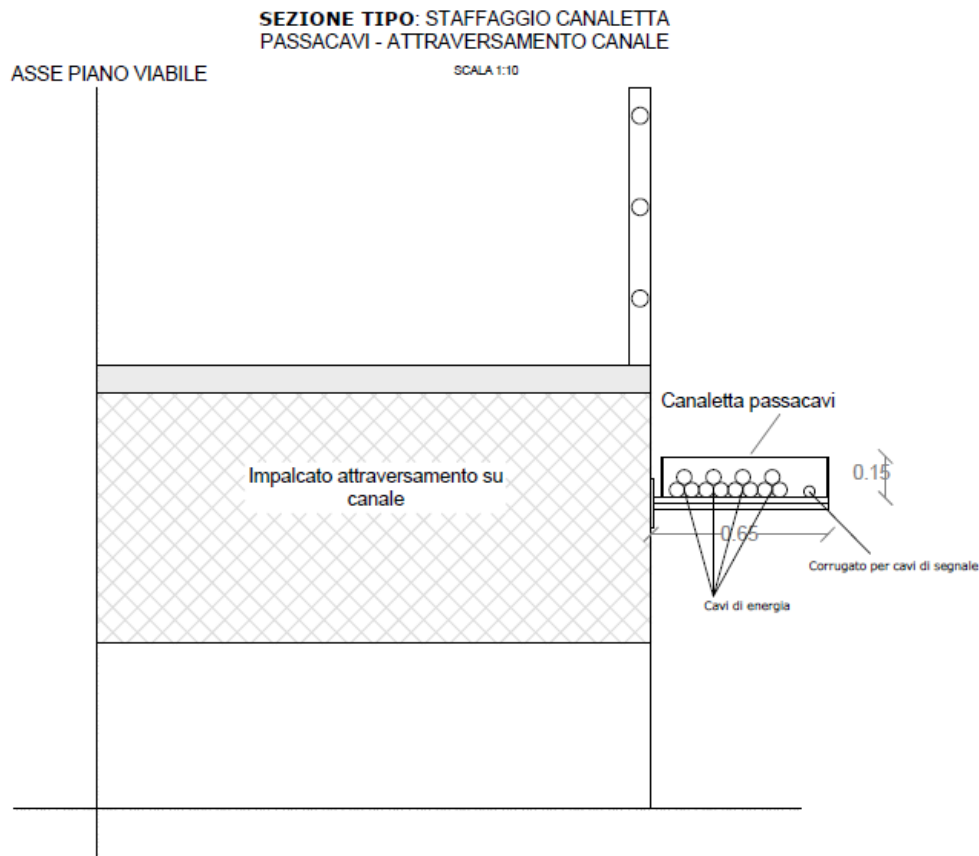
Sezione tipo posa in canaletta in fiancheggiamento al ponte esistente
